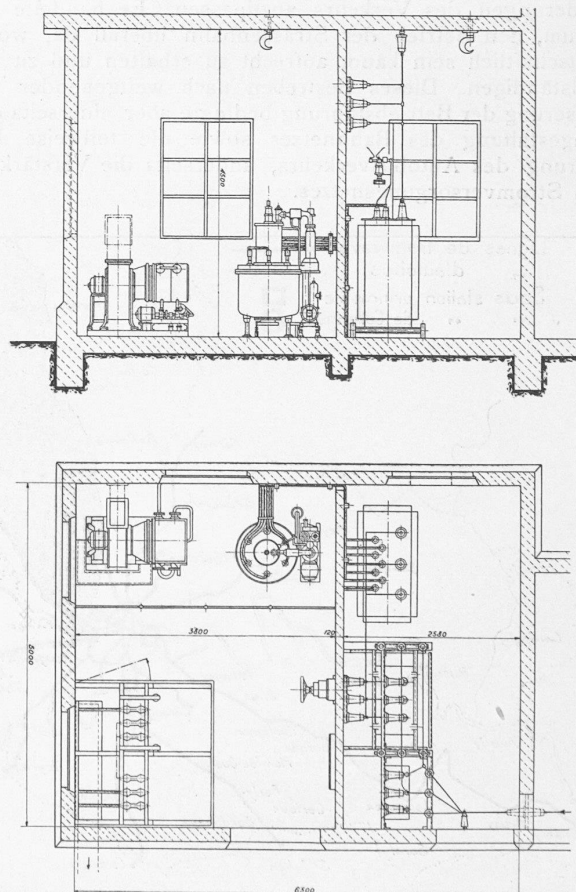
Grundriss und Schnitt der Gleichrichterstation Collonge. — 1:100.
